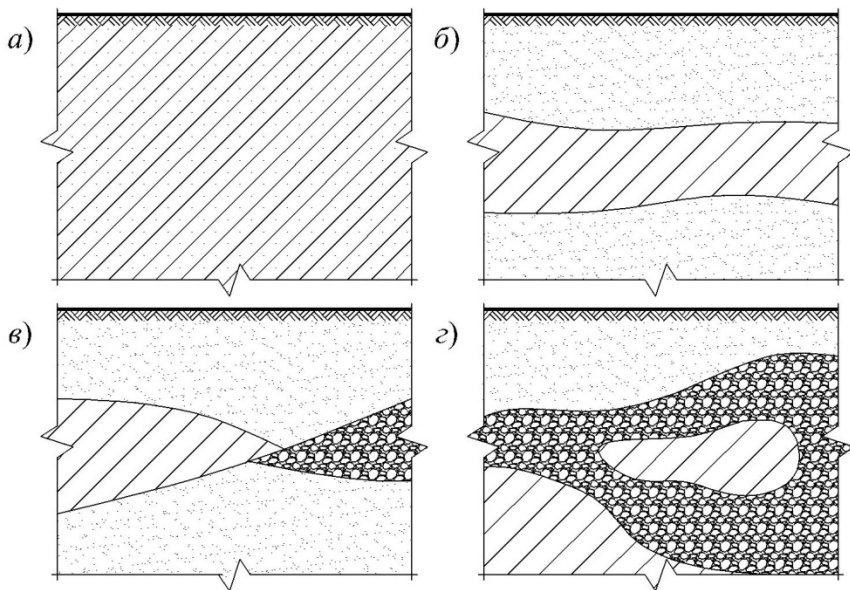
Схемы основания с различным напластованием грунтов:
